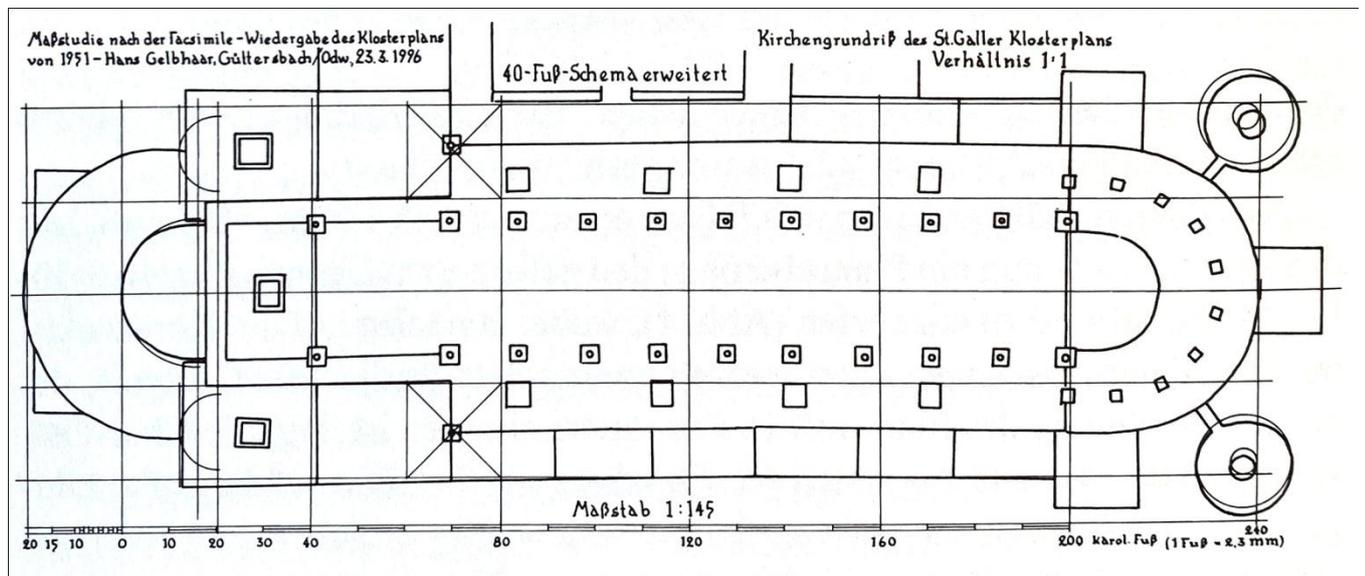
Hans Gelbhaar, Planschema mit 40 Fuß-System erweitert auf Kirchengrundriß.
